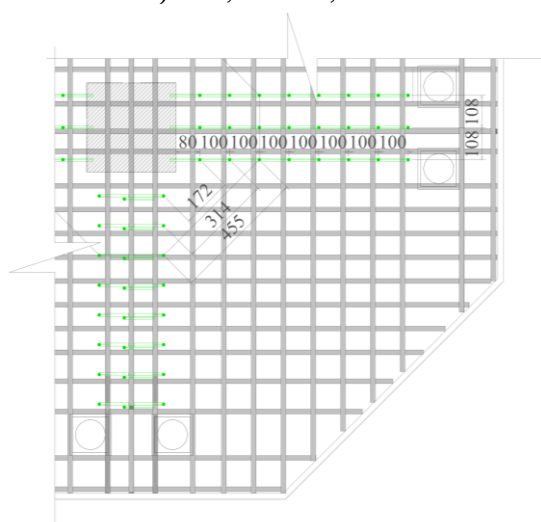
Detalhe das armaduras de cisalhamento instaladas
